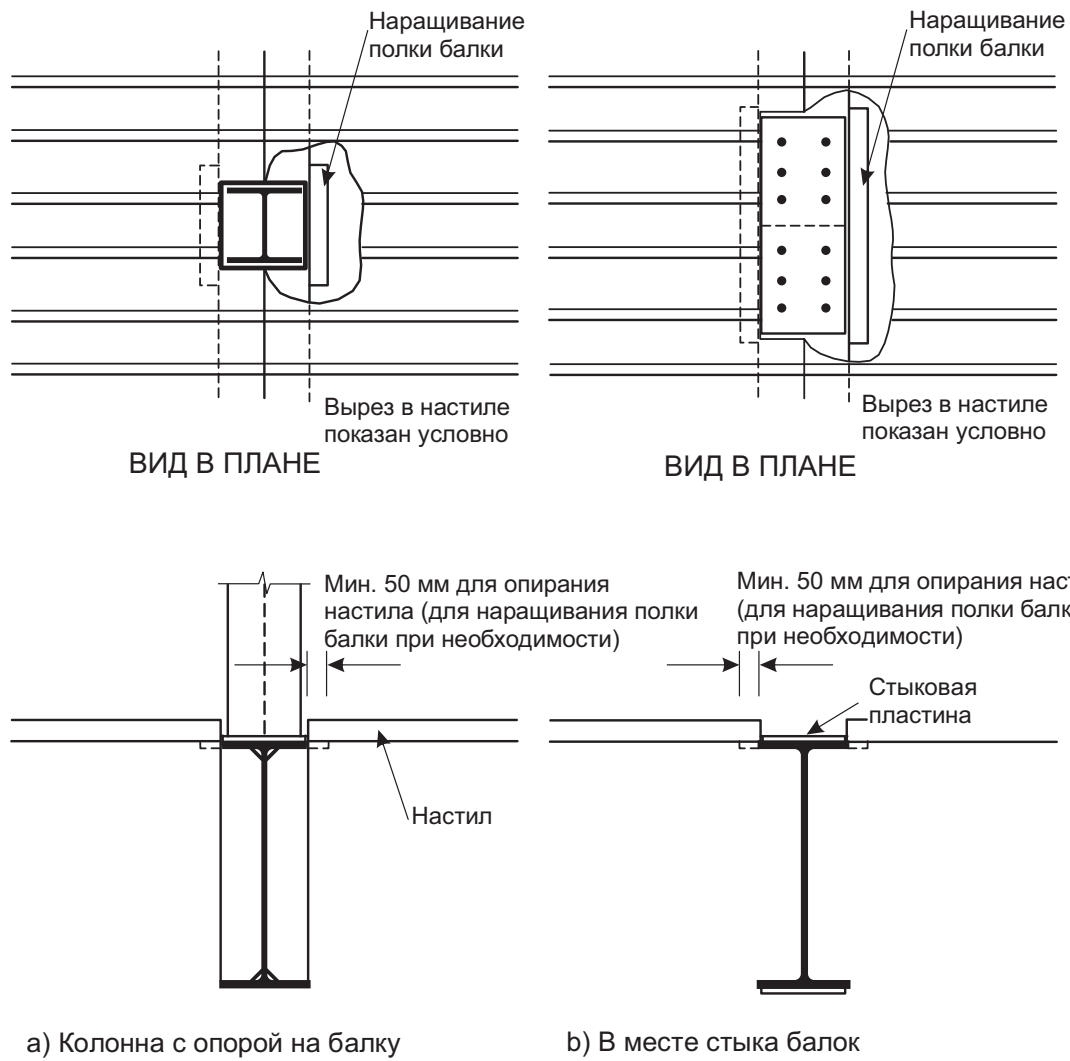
Схемы расположения настила в местах установки колонны на балку и в месте стыка балок каркаса
